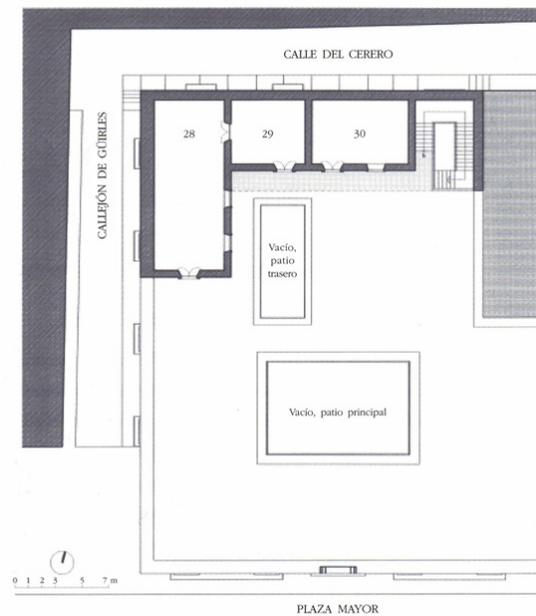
Planta baja, casa marqués de San Clemente, siglo XVIII.
